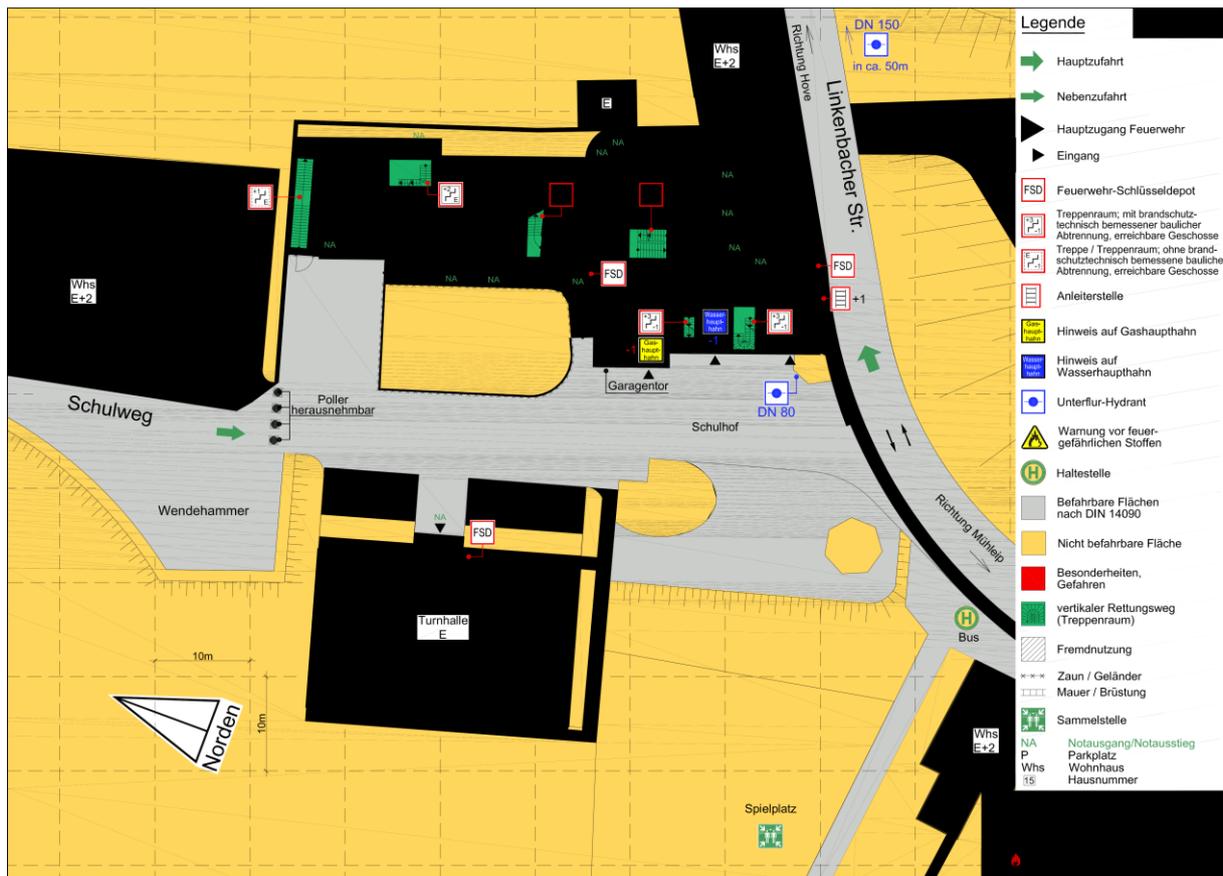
Übersichtsplan Schulgebäude – umrandete Fläche mögliches Bau Feld für Pavillons
